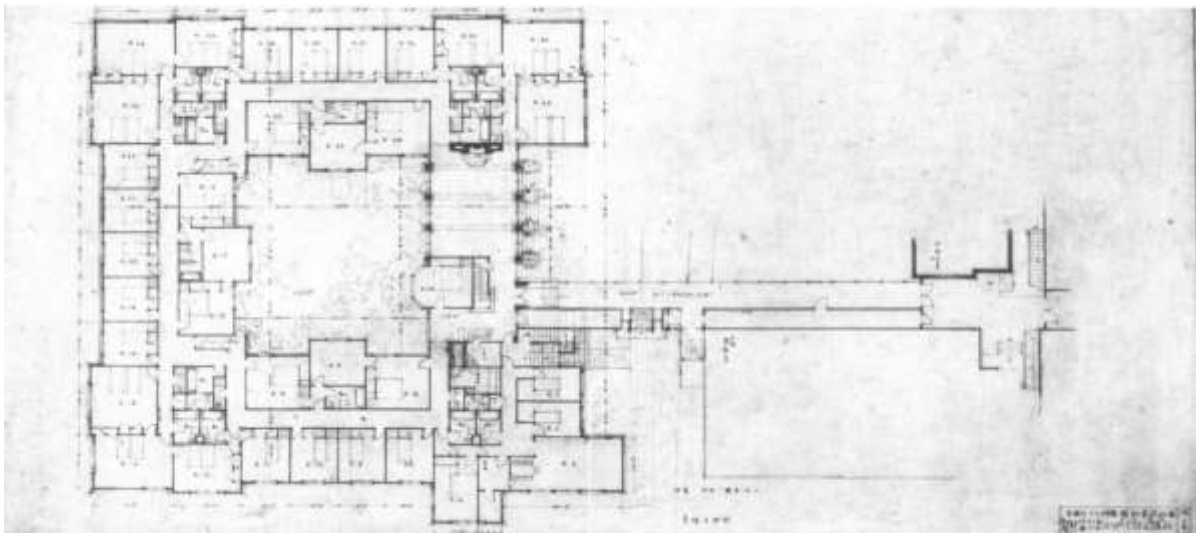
Planta primer nivel Hotel Imperial. Planta del conjunto. Frank Lloyd Wright Arquitecto. En: Kathryn Smith, Frank Lloyd Wright and the Imperial Hotel: A Postscript. Fuente: Frank Lloyd Wright Foundation, 1982.
